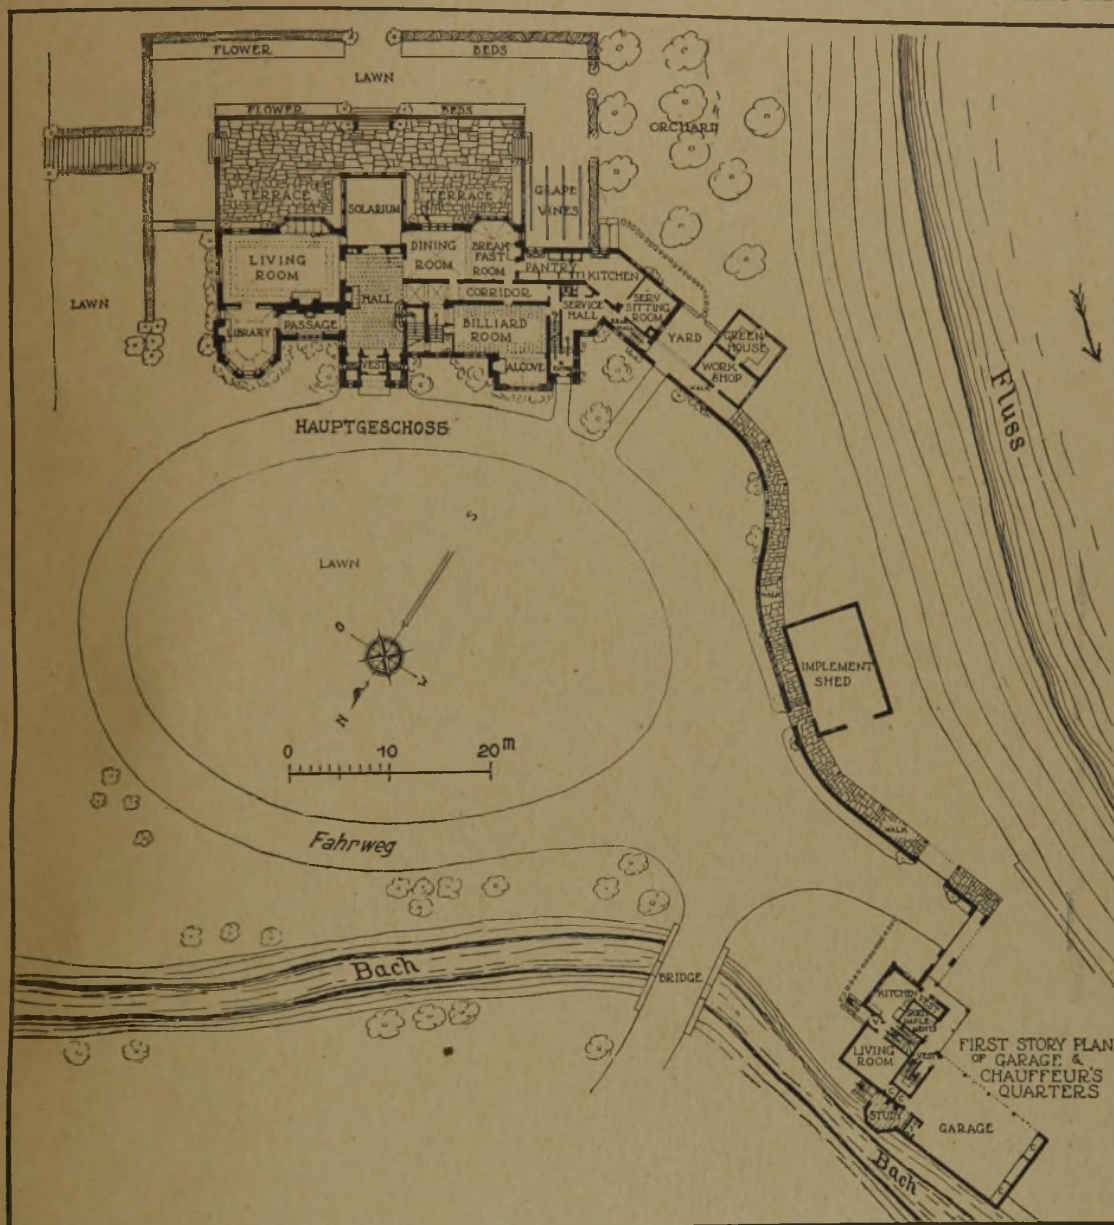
Lageplan des Herrenhaus-Grundstücks mit Grundriß des Herrenhauses und der Garage.
